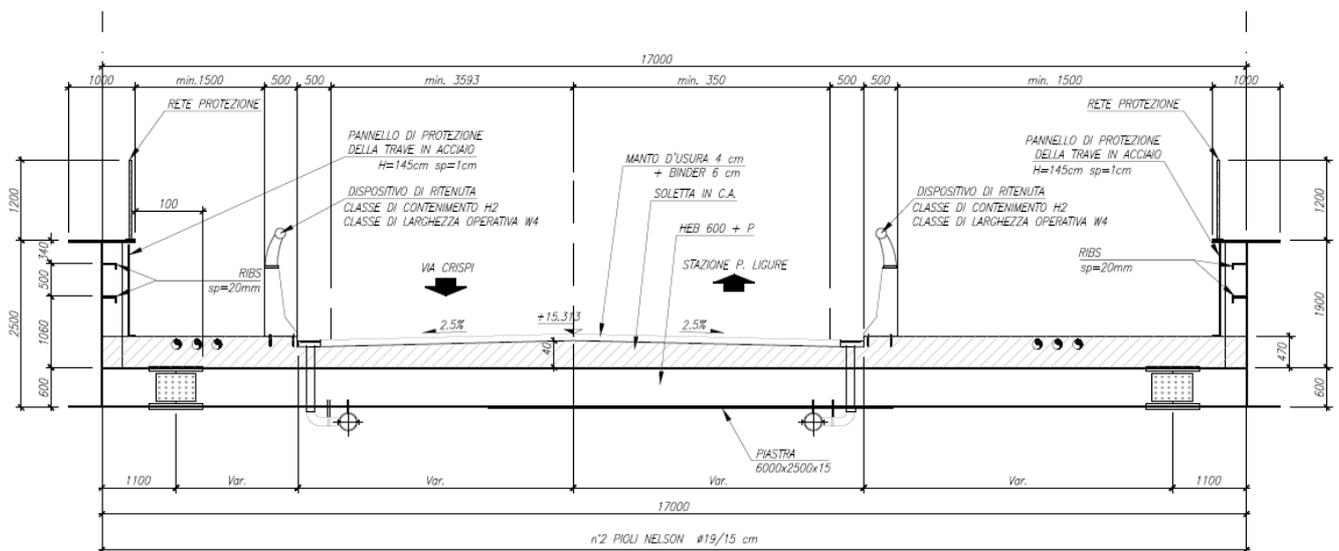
Sezione trasversale Impalcato (Sezione A-A)
